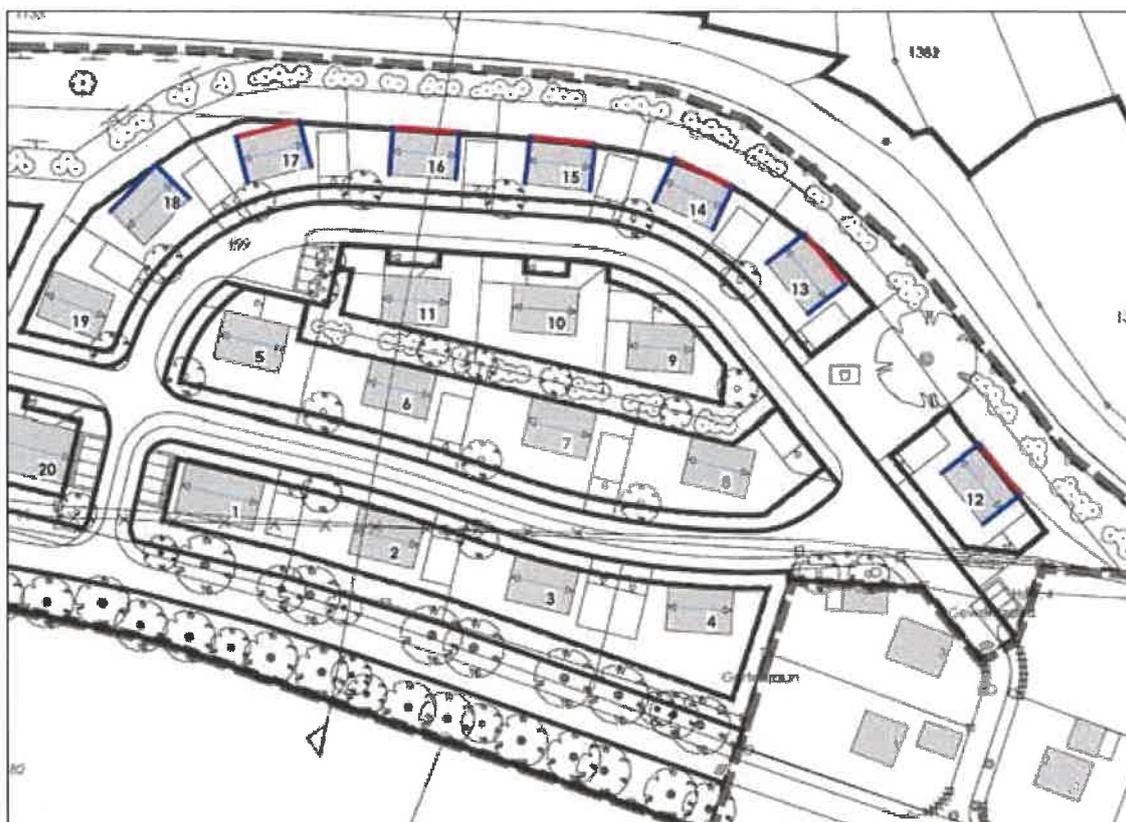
Lageplan mit Kennzeichnung der Fassaden, an denen passiver Schallschutz erforderlich ist (Maßstab 1:1.500)
